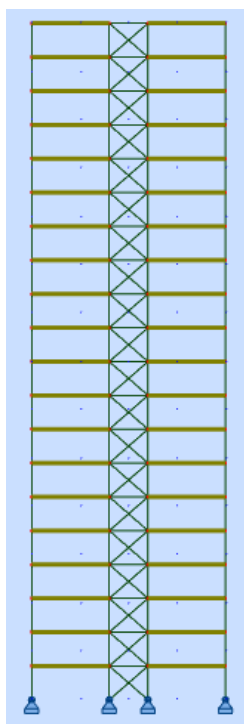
Contraventamento paralelo à menor dimensão em planta baixa
